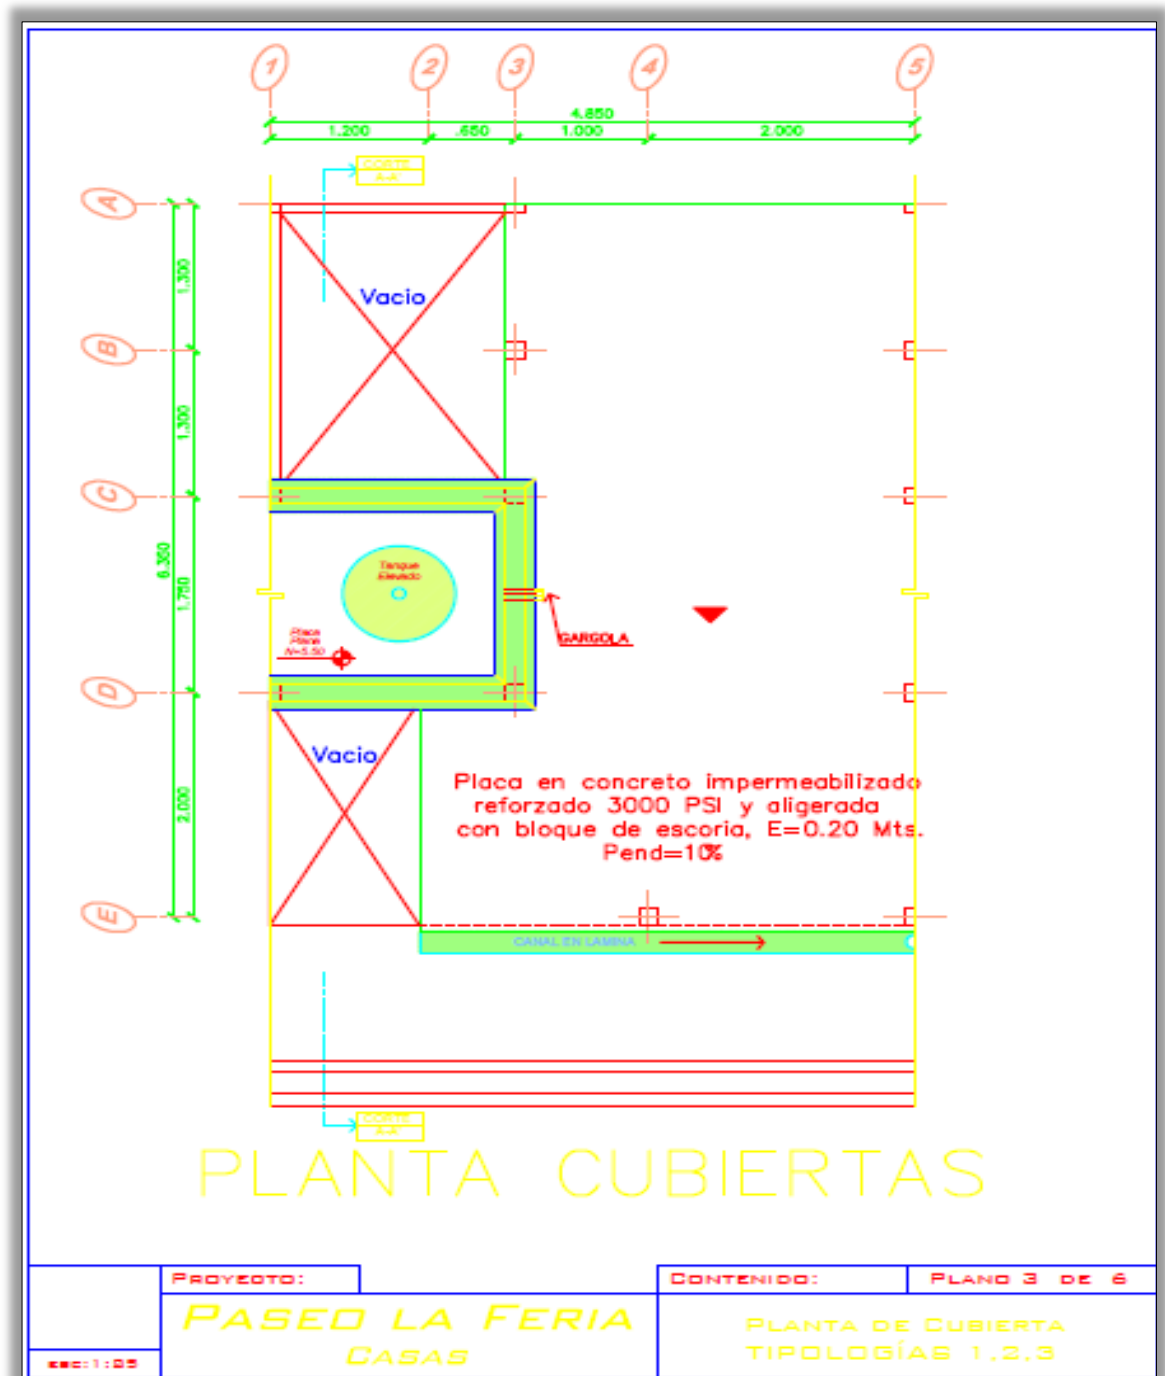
Plano cubiertas: vivienda tipo seleccionada [20]
